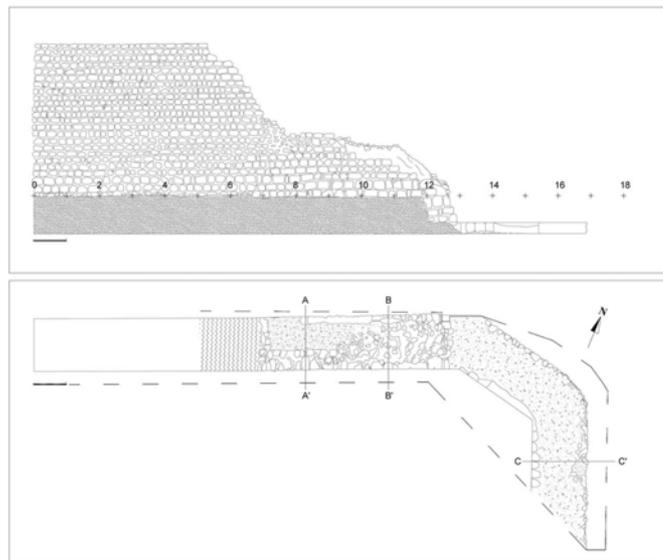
Muro de la casamata, baluarte de Santa Llúcia.
